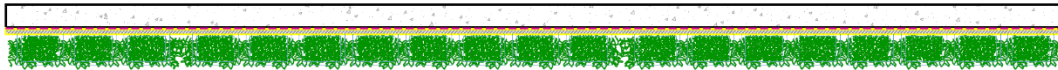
Planta com a vegetação cobrindo completamente a parede.
